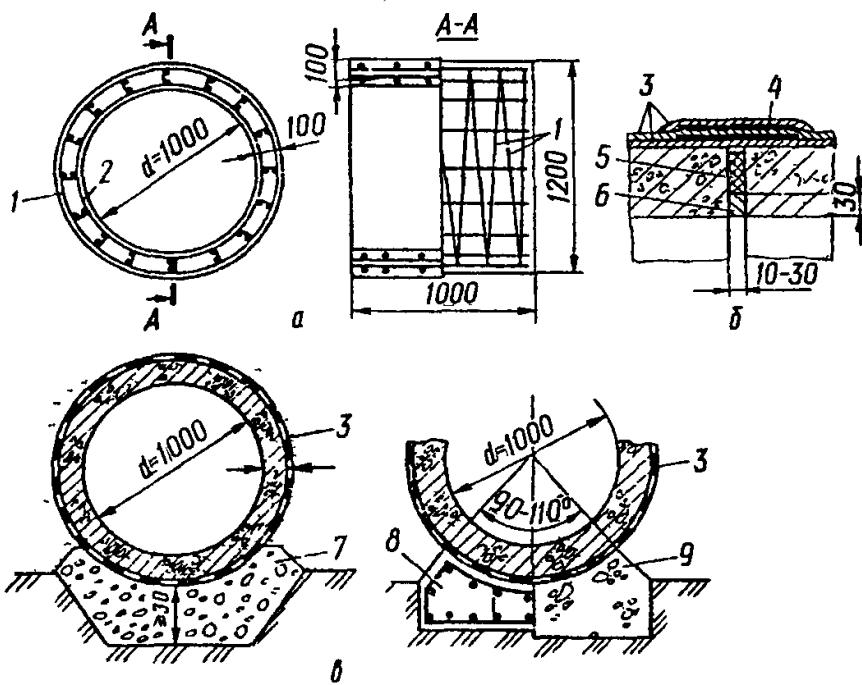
Конструкція ланок круглих залізобетонних труб.
